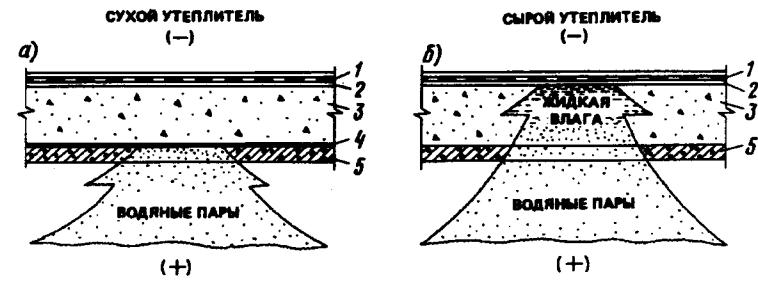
Проникновение водяных паров в конструкцию бесчердачного перекрытия при устройстве пароизоляции (а) и без нее (б)
